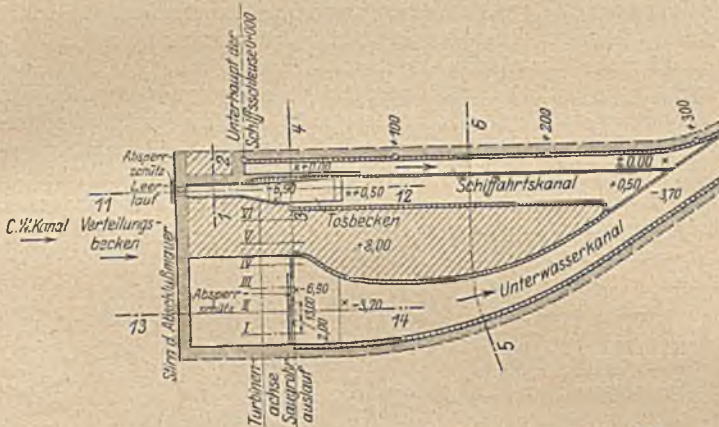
a. Lageplan des ursprünglichen Bauentwurfes (Modell „I“) Maßstab 1 : 5000.
